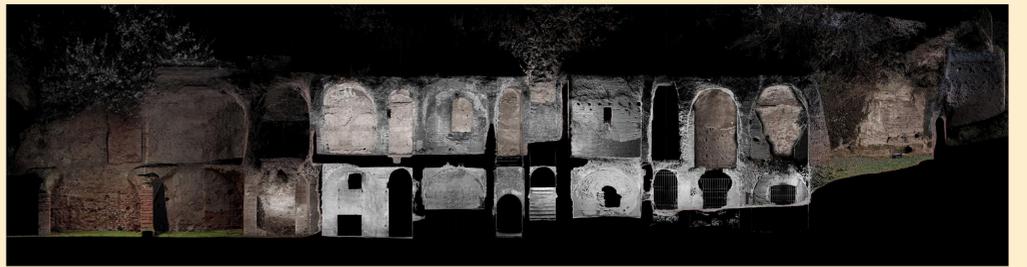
Palatino. Insula orientale. Prospetto e sezione (foto e rilievo Azimut)
